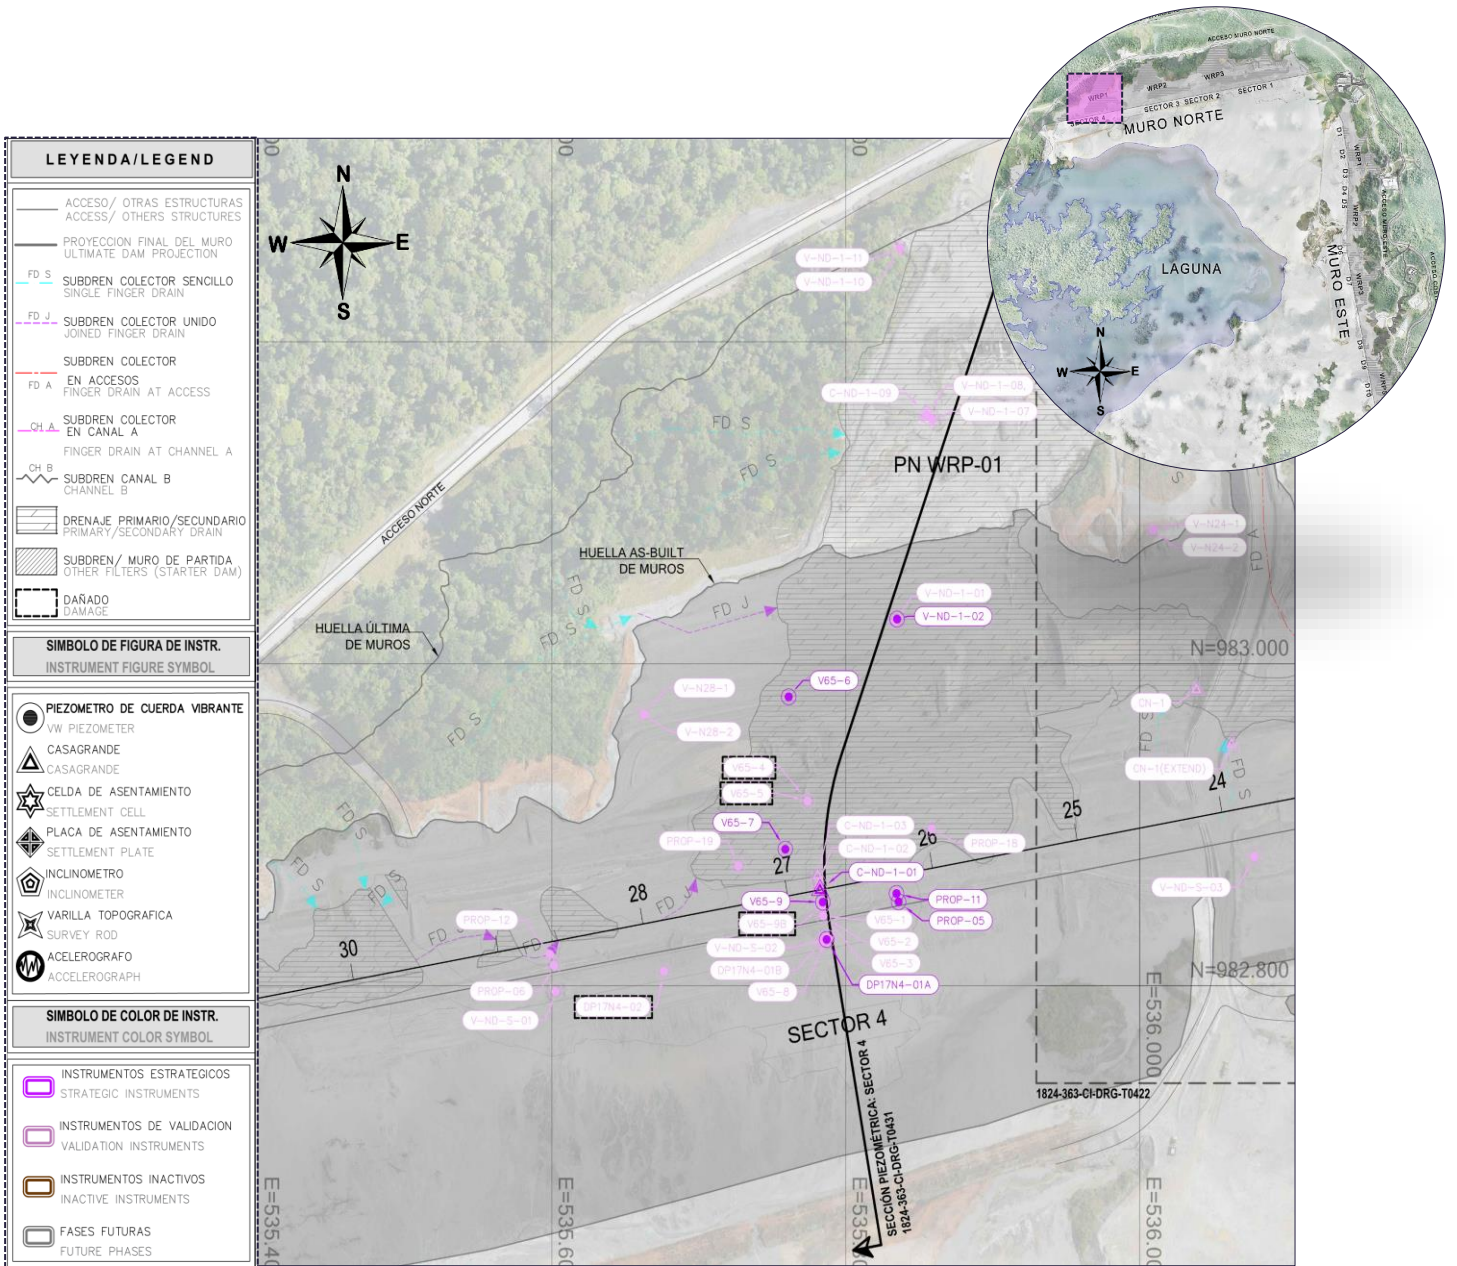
Vista de Planta en Muro Norte Sector 4 - WRP1 con Piezómetros
